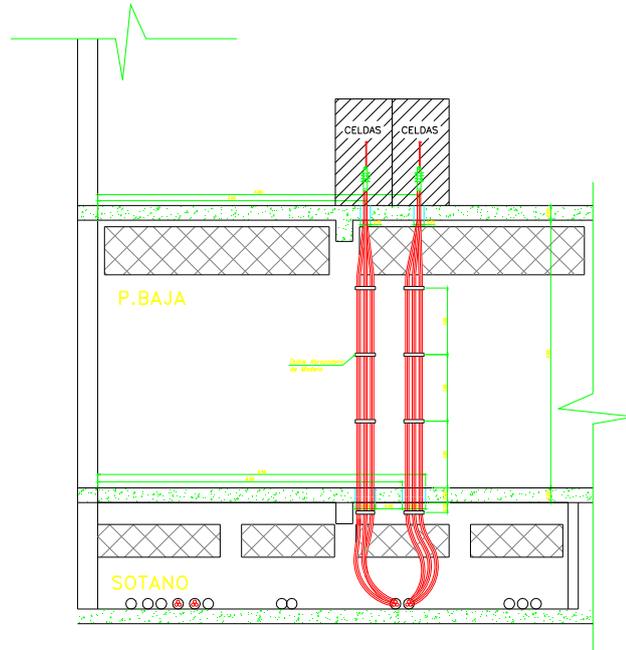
Salida de cables de 21 kV, Corte C-C.
